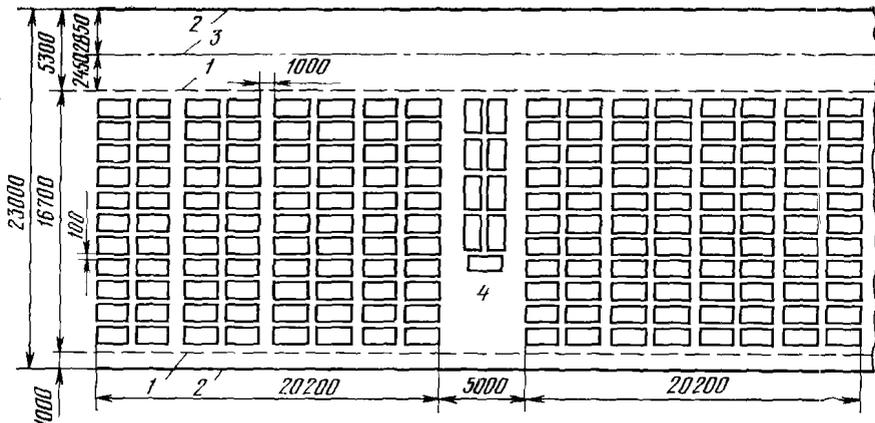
Схема размещения контейнеров на площадке, оборудованной мостовым краном с пролетом 23 м:
